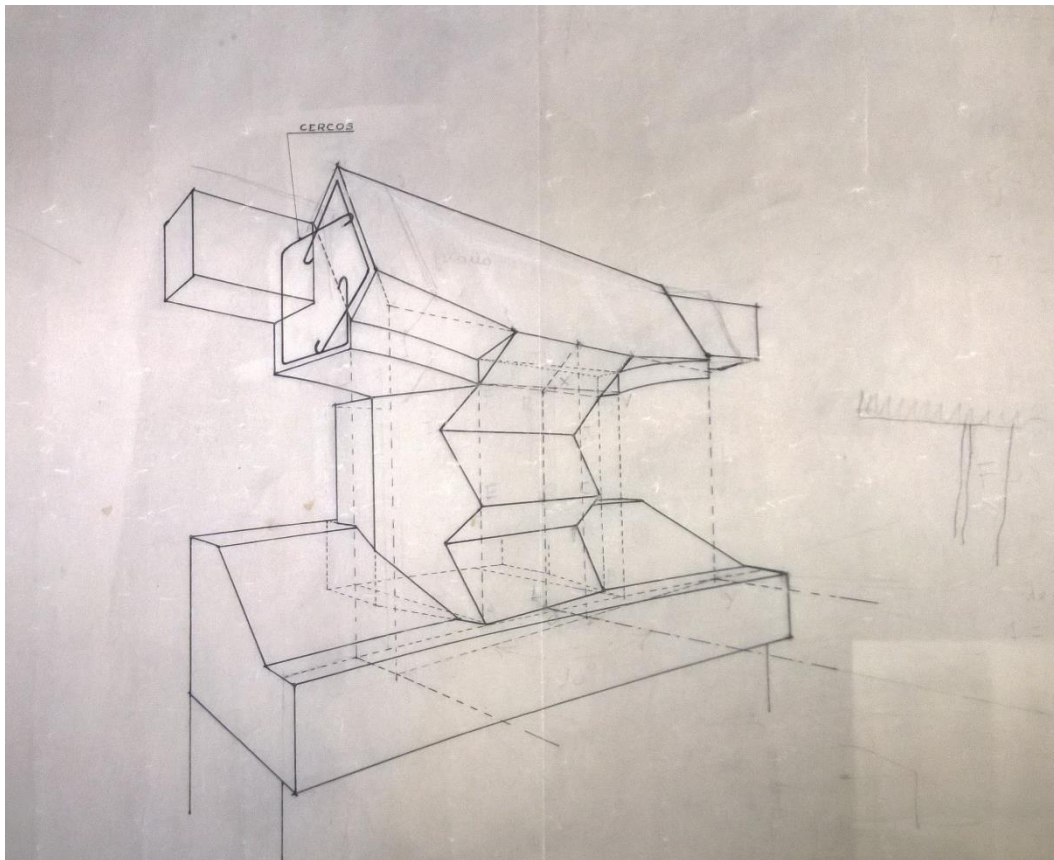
Plano detalle del anillo exterior de hormigón armado. Diseño de Luis Moya.
